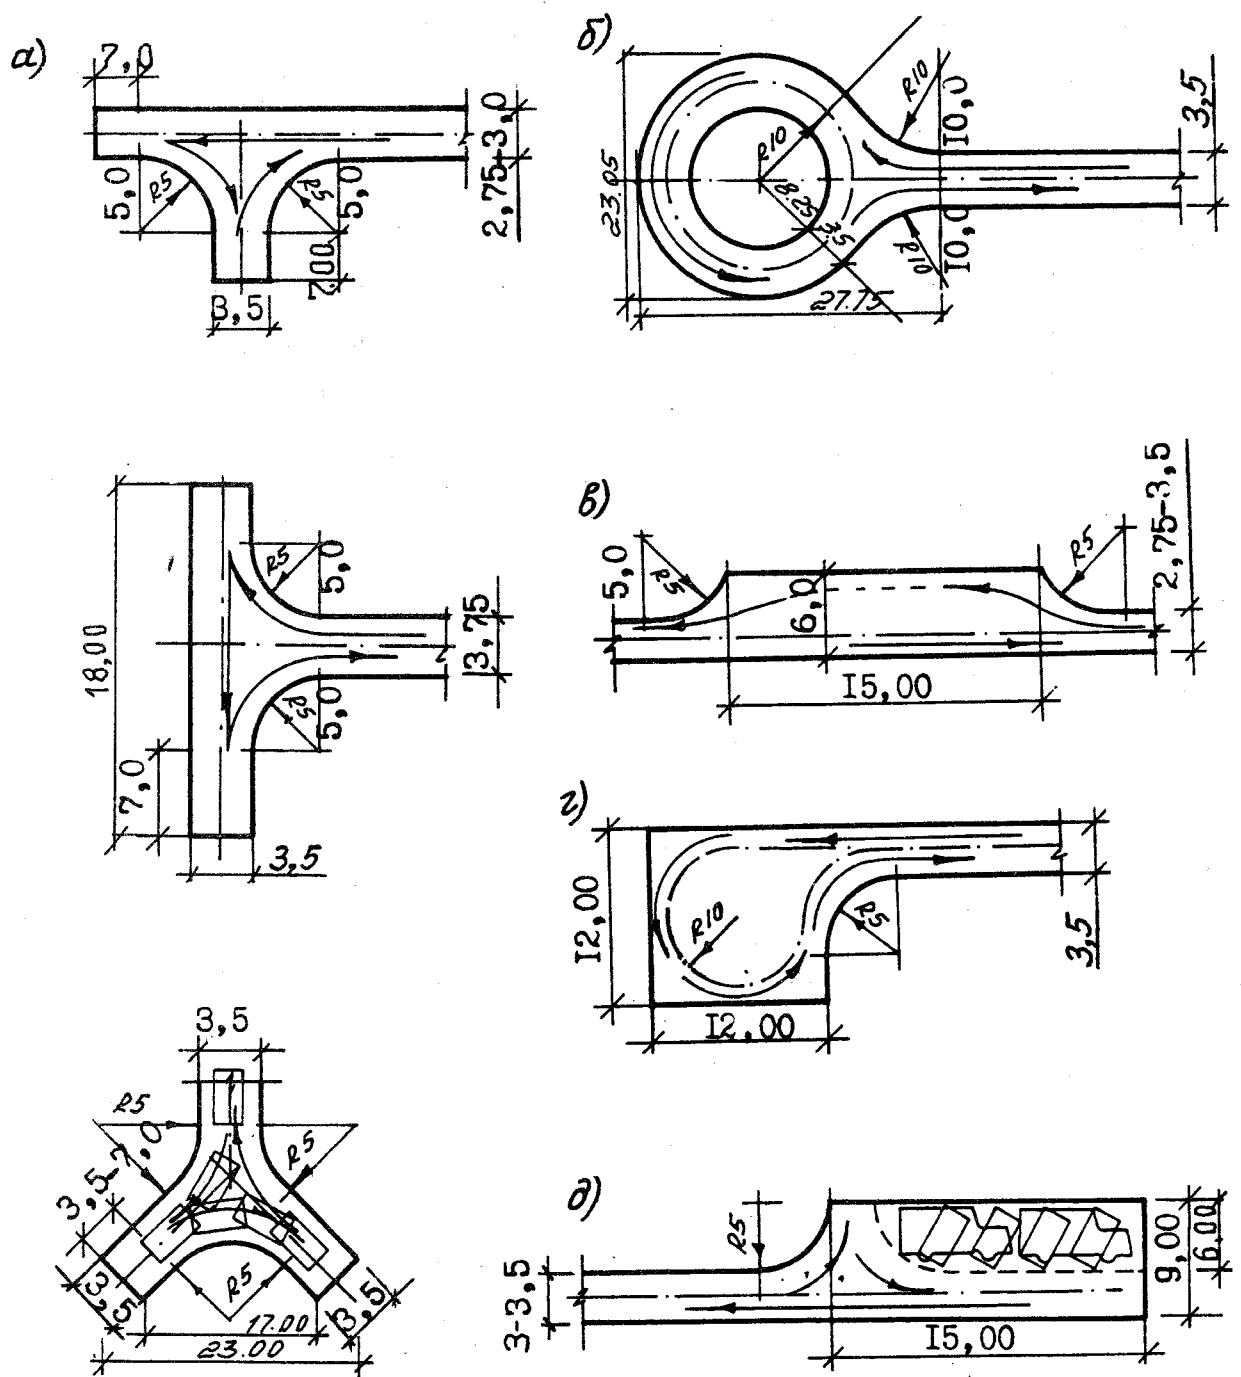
Планировочные схемы поворотных и разворотных площадок на внутриквартальных проездах: а - площадки для разворота задним ходом; б - кольцевая поворотная площадка; в - разъездная площадка на проезжей части; г - тупиковая разворотная площадка; разворот передним ходом; д - разъездная тупиковая площадка с местом для стоянки
